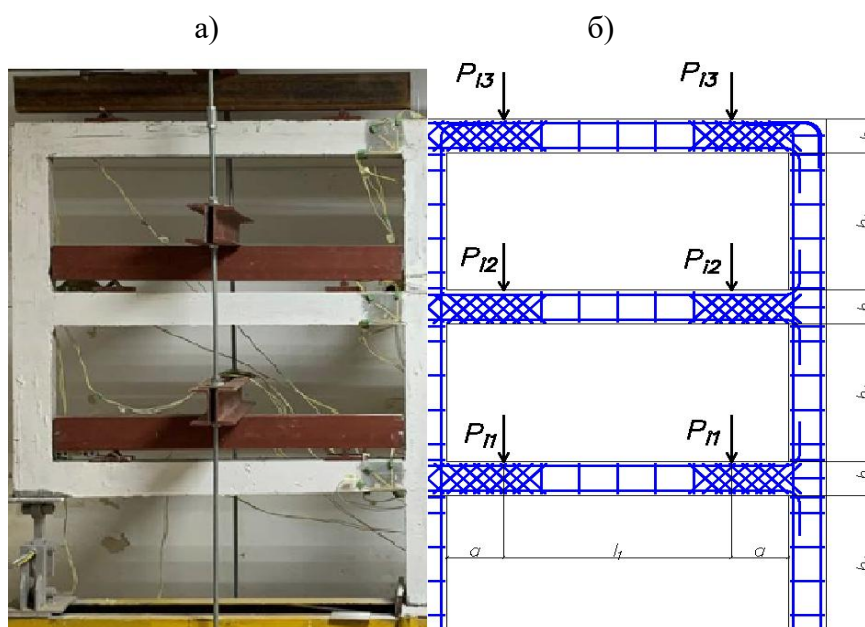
Общий вид испытанной конструкции железобетонной рамы (а), схема армирования и приложения нагрузок (б)
